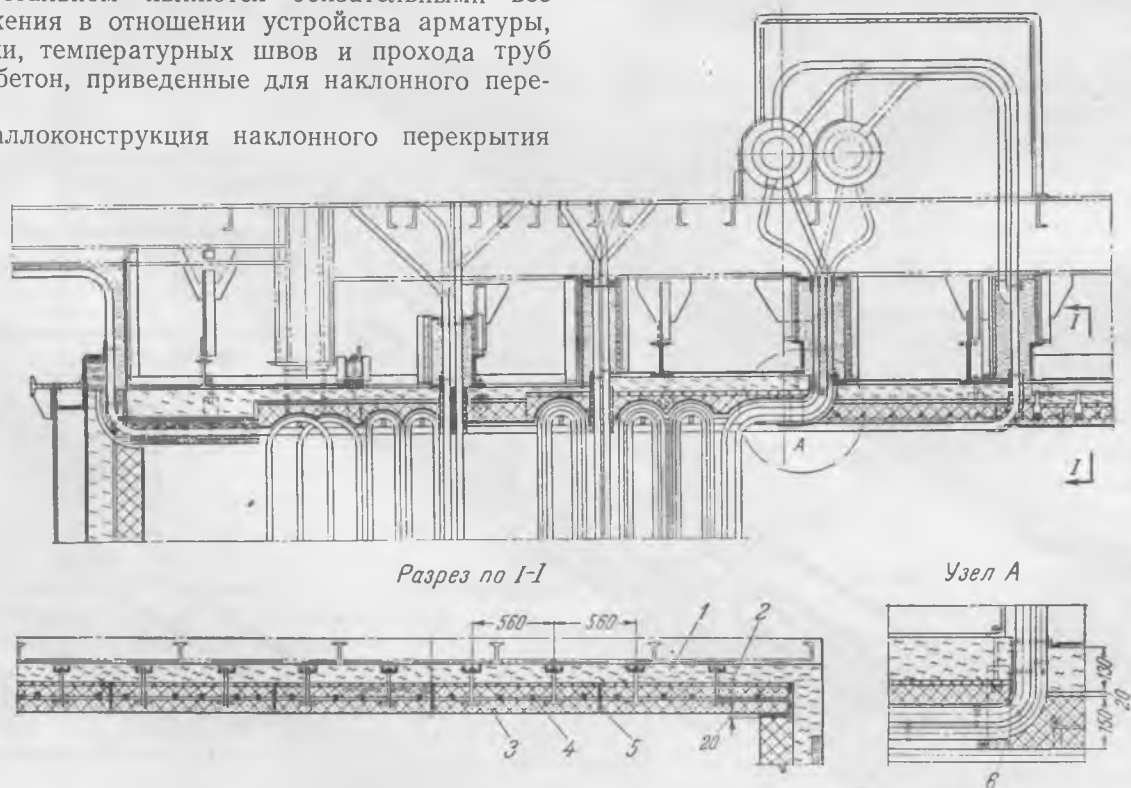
Горизонтальное перекрытие из огнеупорного бетона для котла ТП-230.
